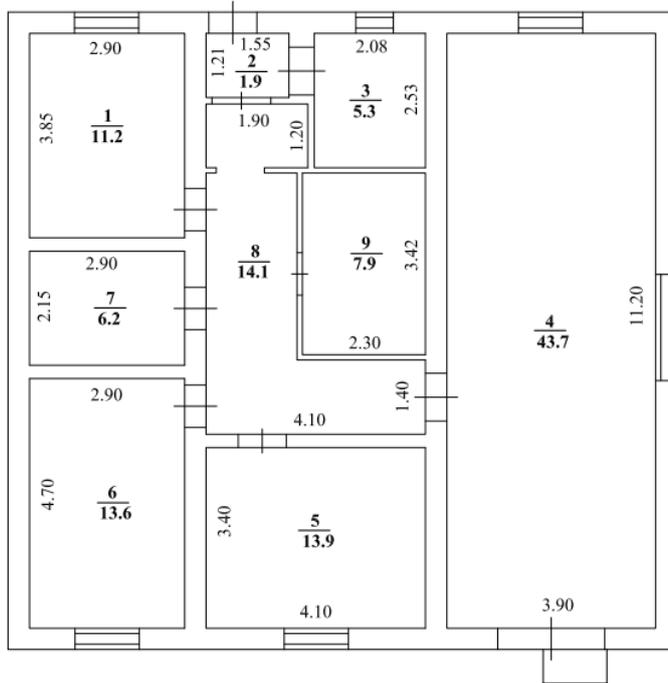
Поэтажный план здания – объекта кадастровых работ
